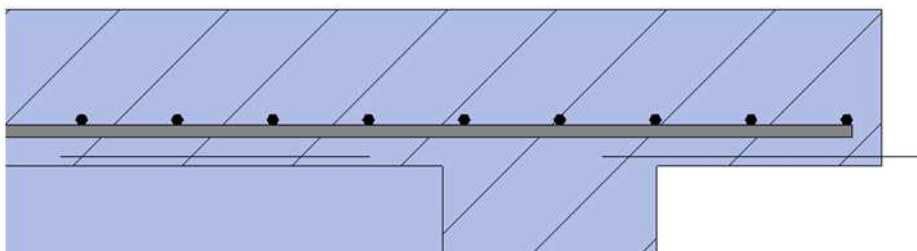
Mise en place des armatures dans la dalle du local technique en toiture
